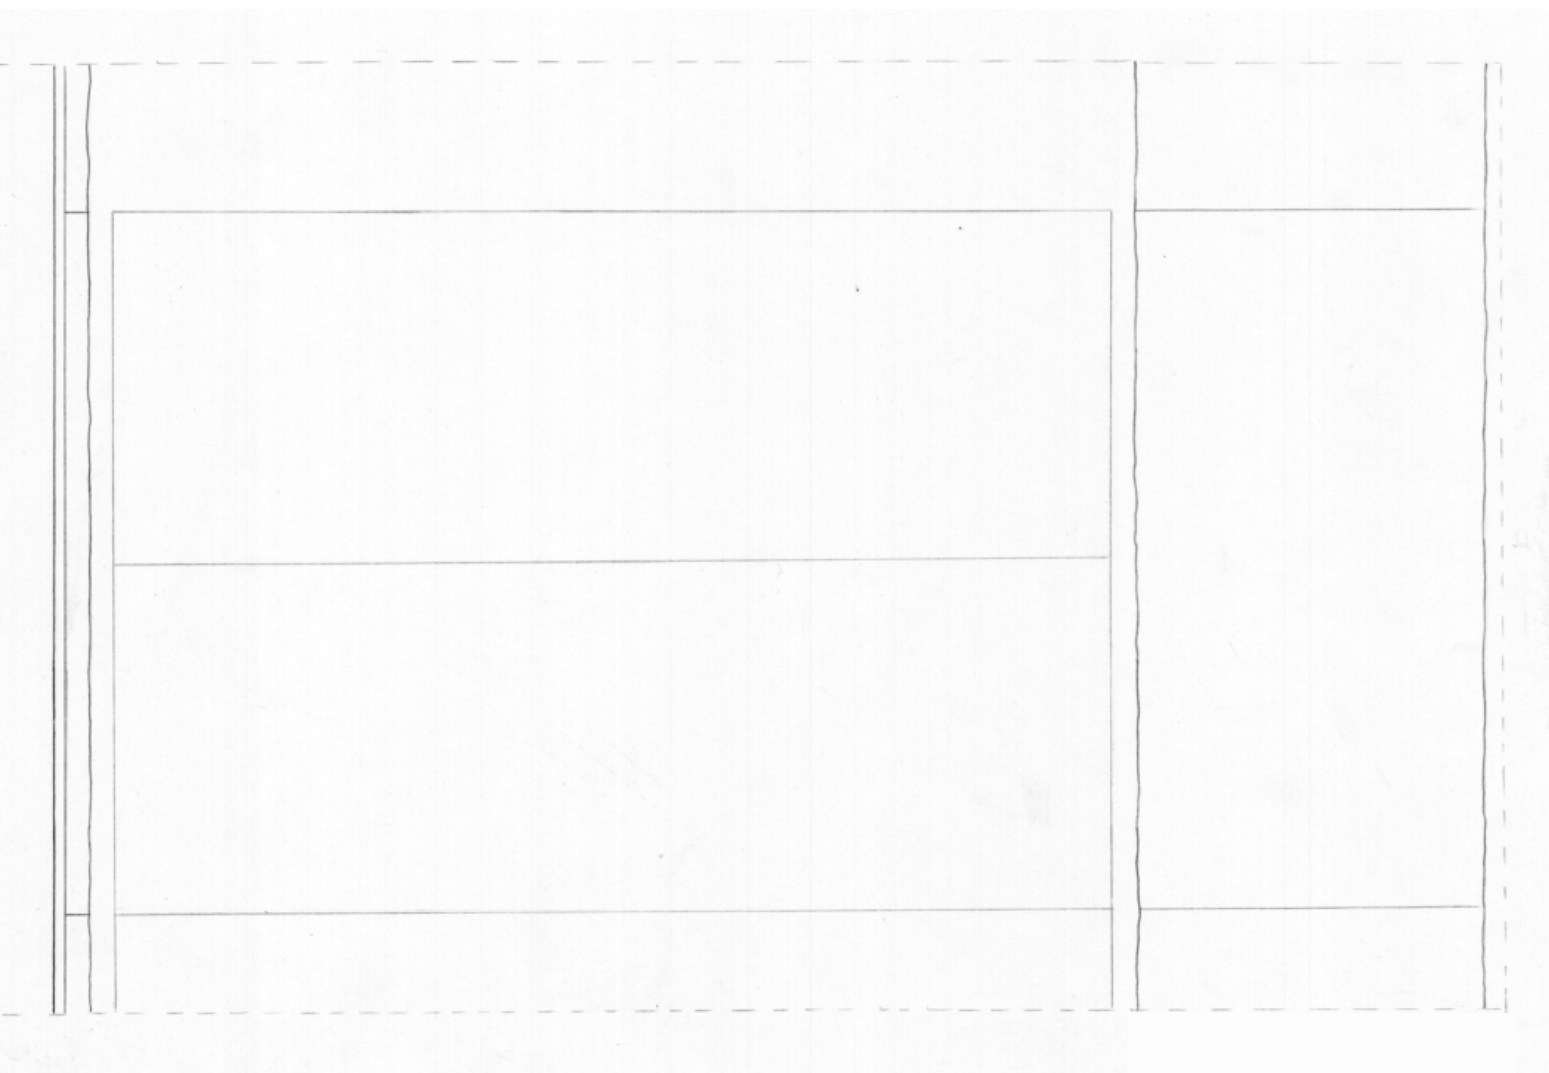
D3 - Detalhe em planta da escada exterior, escala 1:10.
